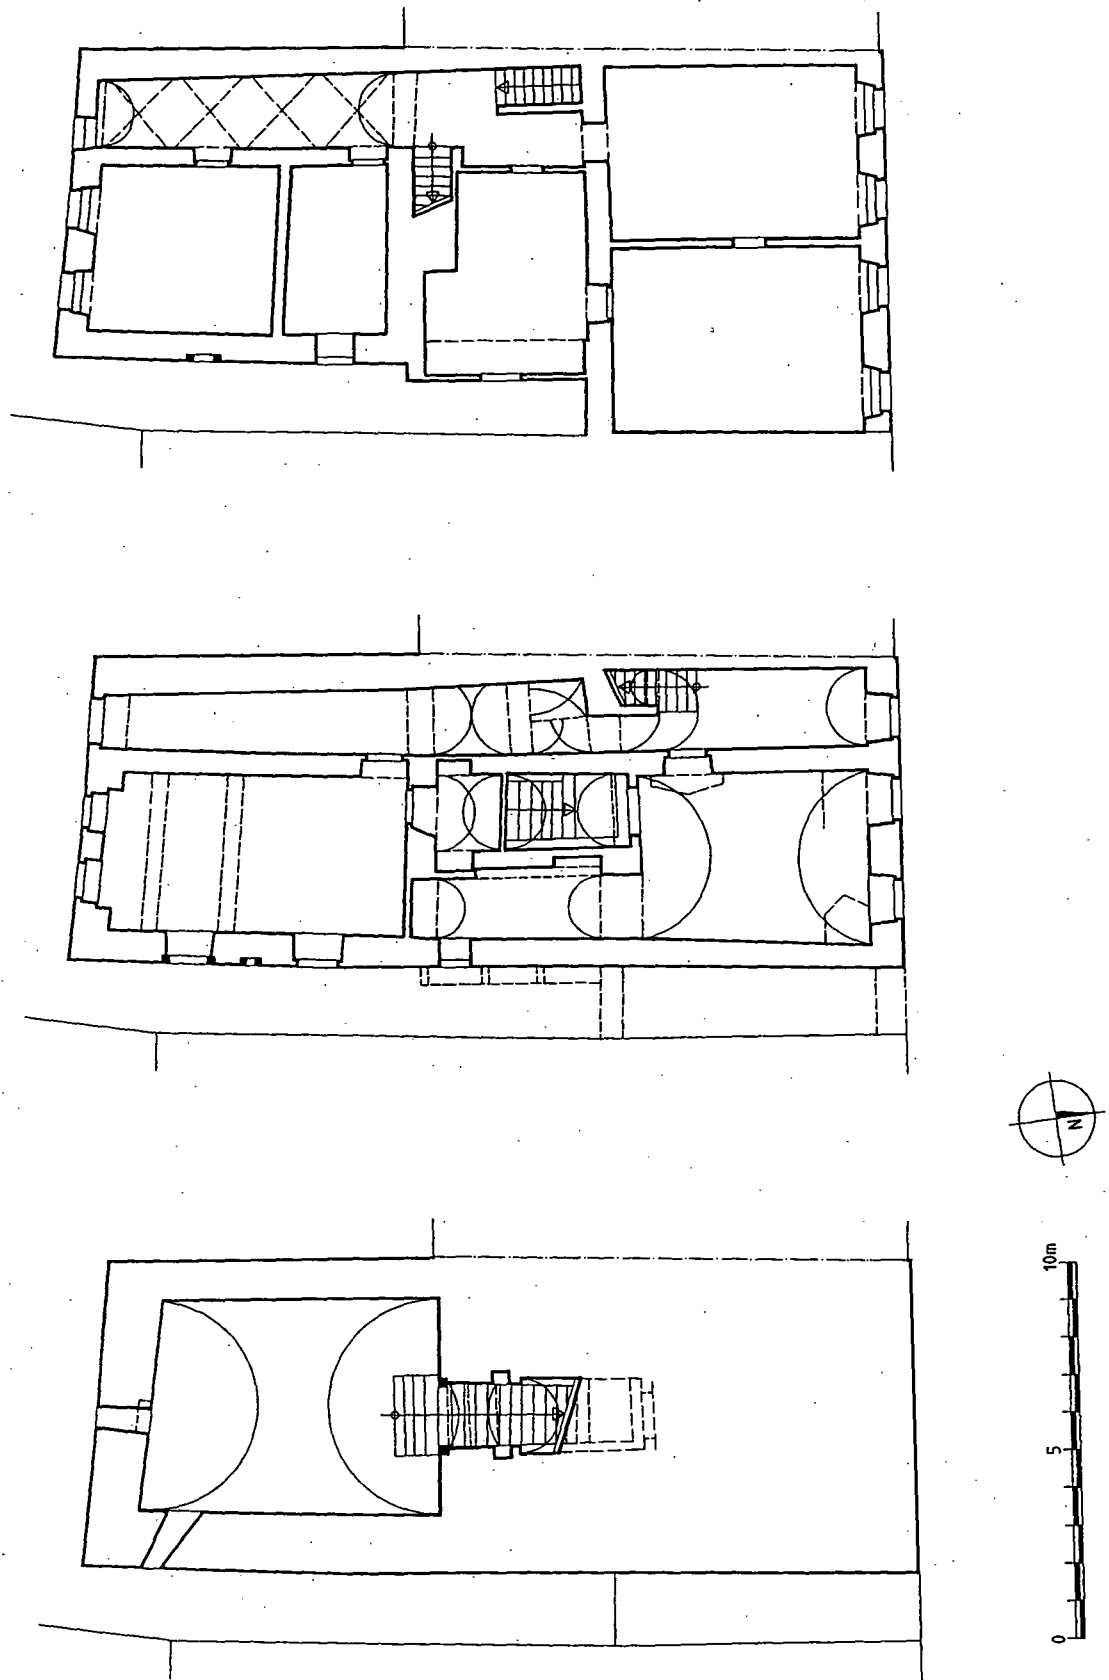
Schmiedstraße 19 – Grundrisse Keller, Erdgeschoss, Obergeschoss (1:200).
